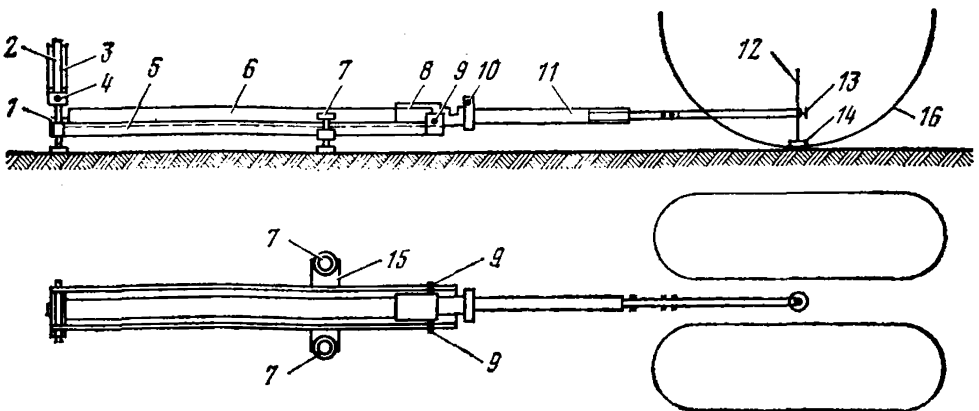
Схема рычажного прогибомера конструкции МАДИ-ЦНИЛ
